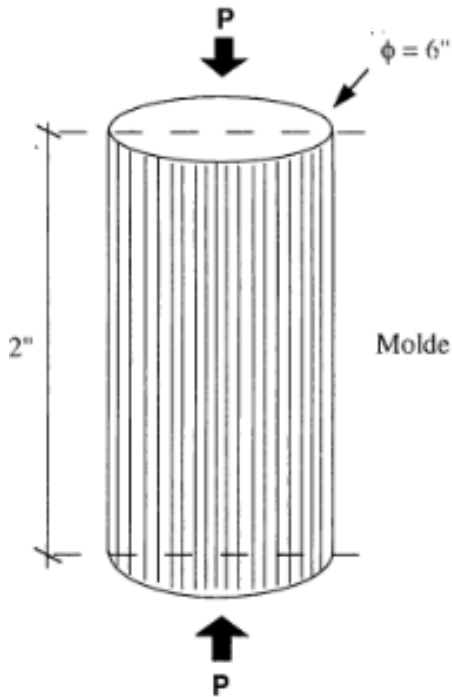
Medidas de un testigo de concreto para el ensayo de compresión.
